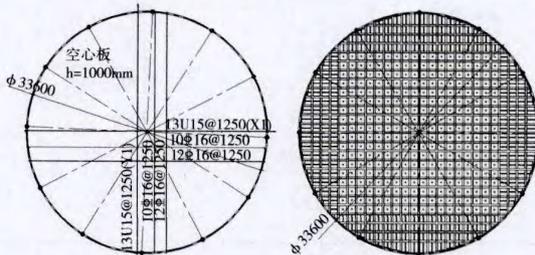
义乌复元医院预应力空心板平面图与填充材料布置图
